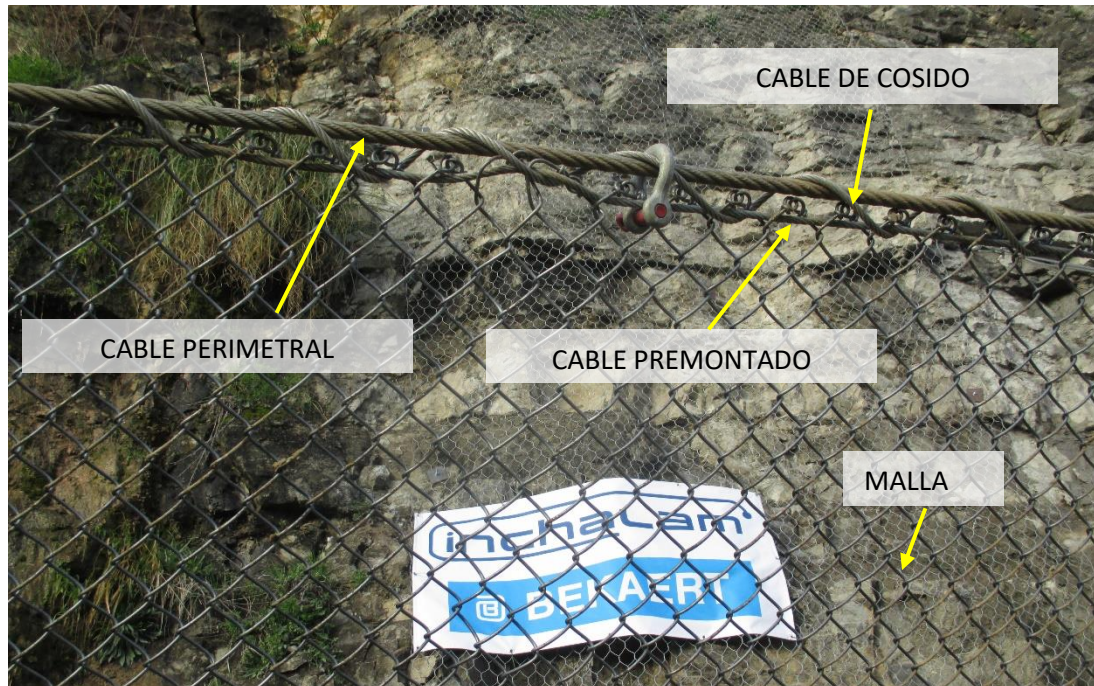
Malla MT15000, cable perimetral, cable premontado y cable de cosido.
